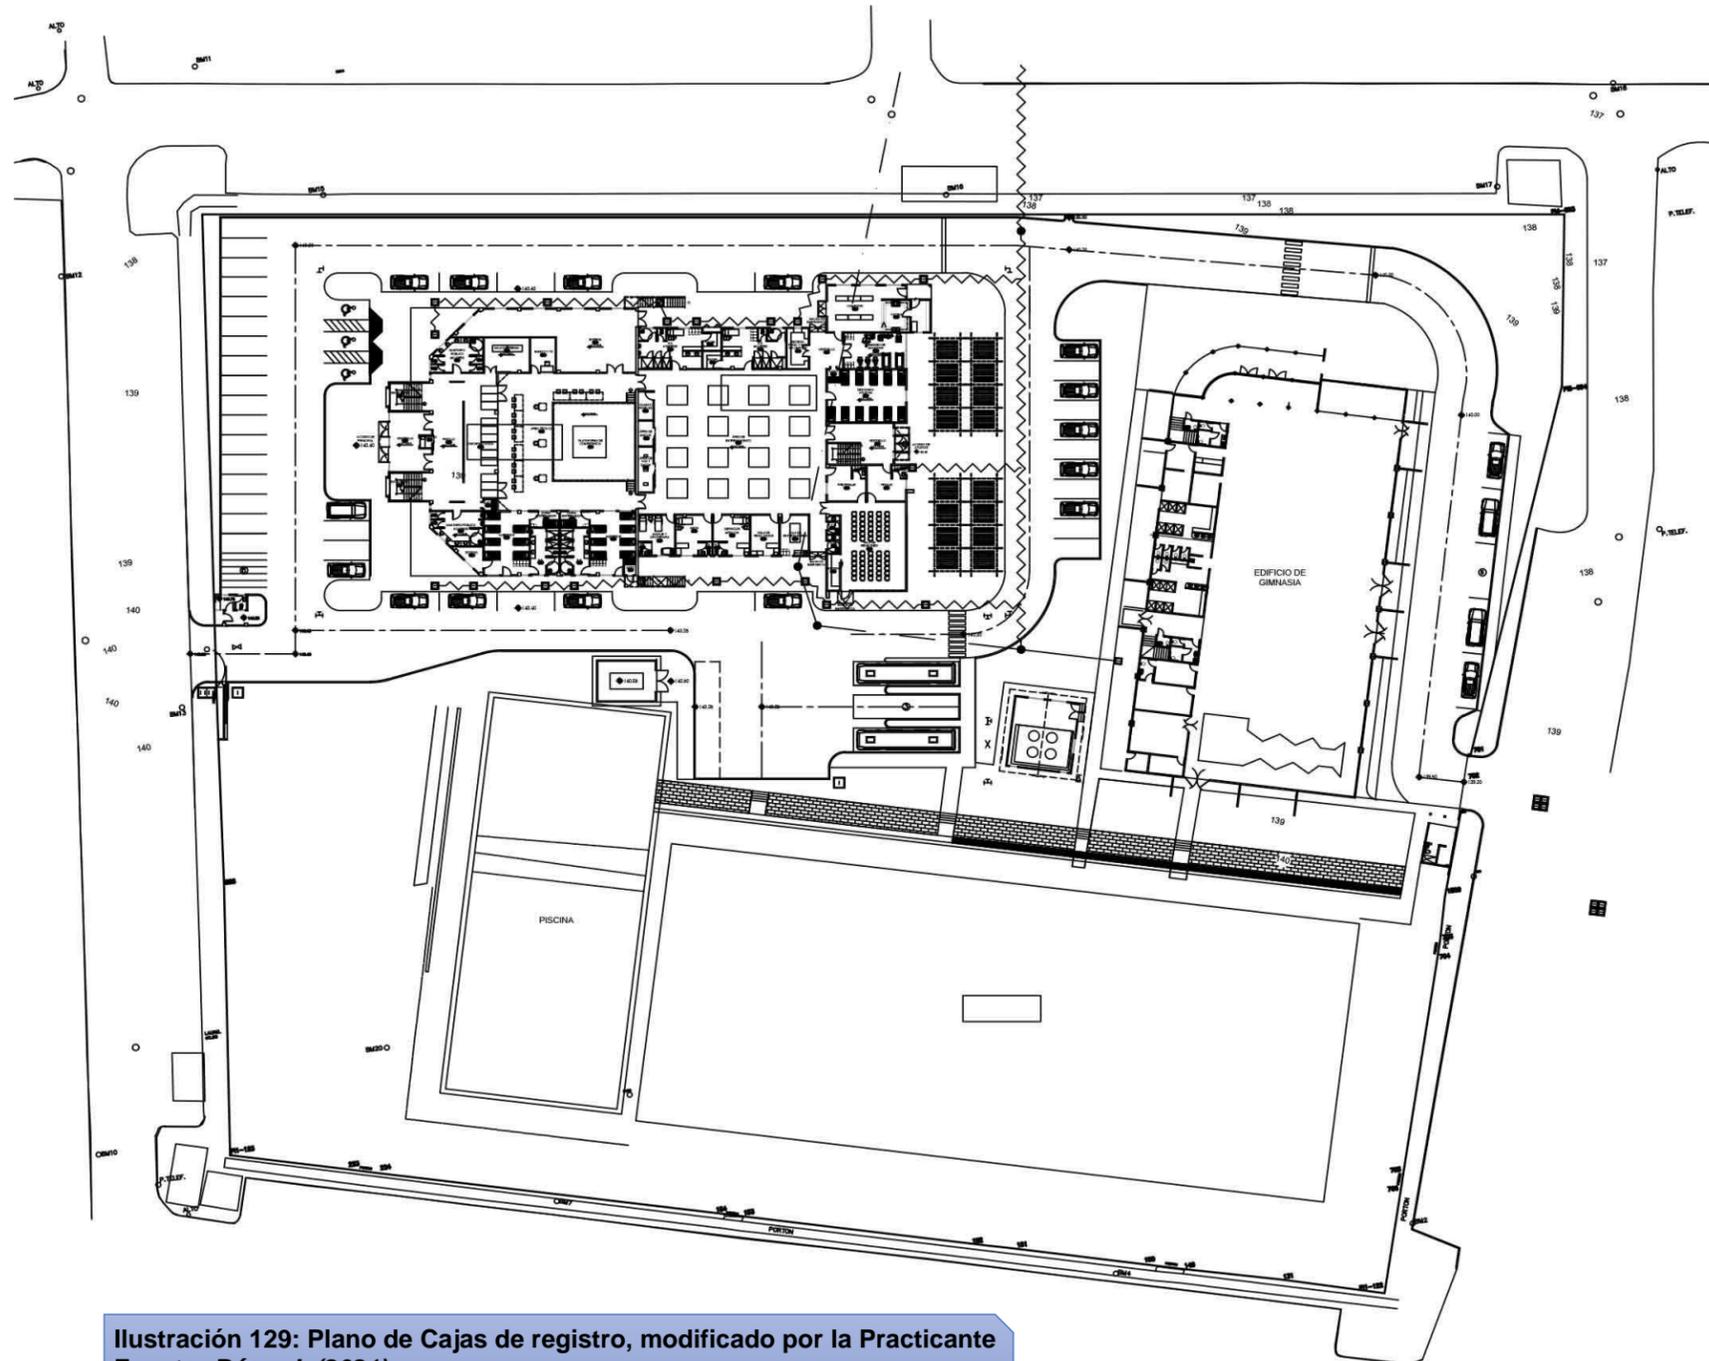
Plano de Cajas de registro, modificado por la Practicante
